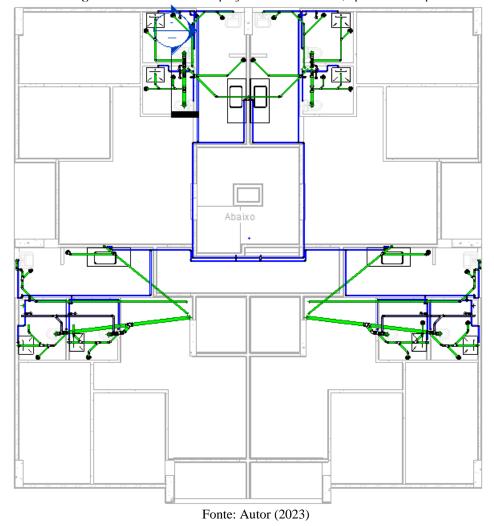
Planta baixa do projeto Hidrossanitário, apartamento tipo.
